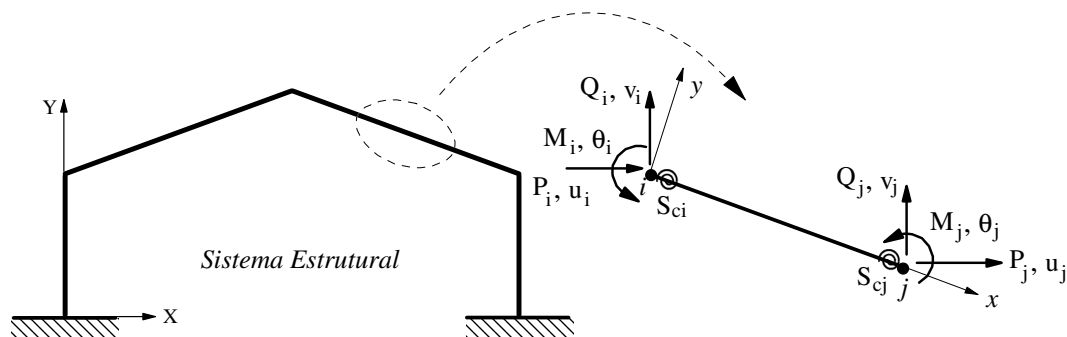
Elemento de viga-coluna com ligações semirrígidas
